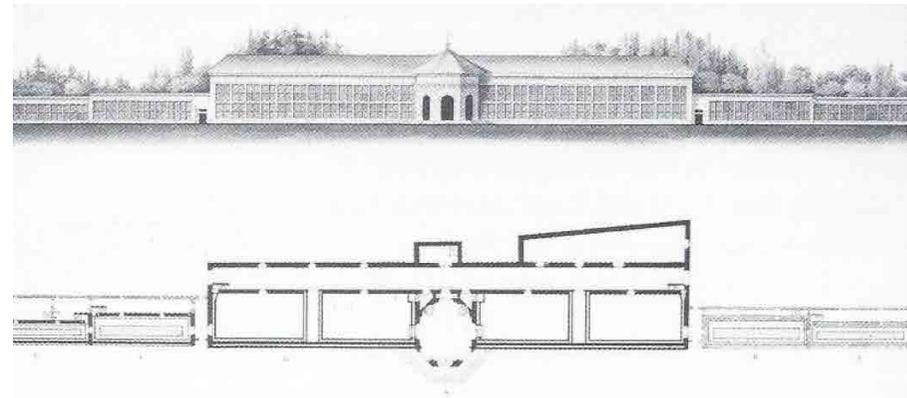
Grundriss und Ansicht der Orangerie.
